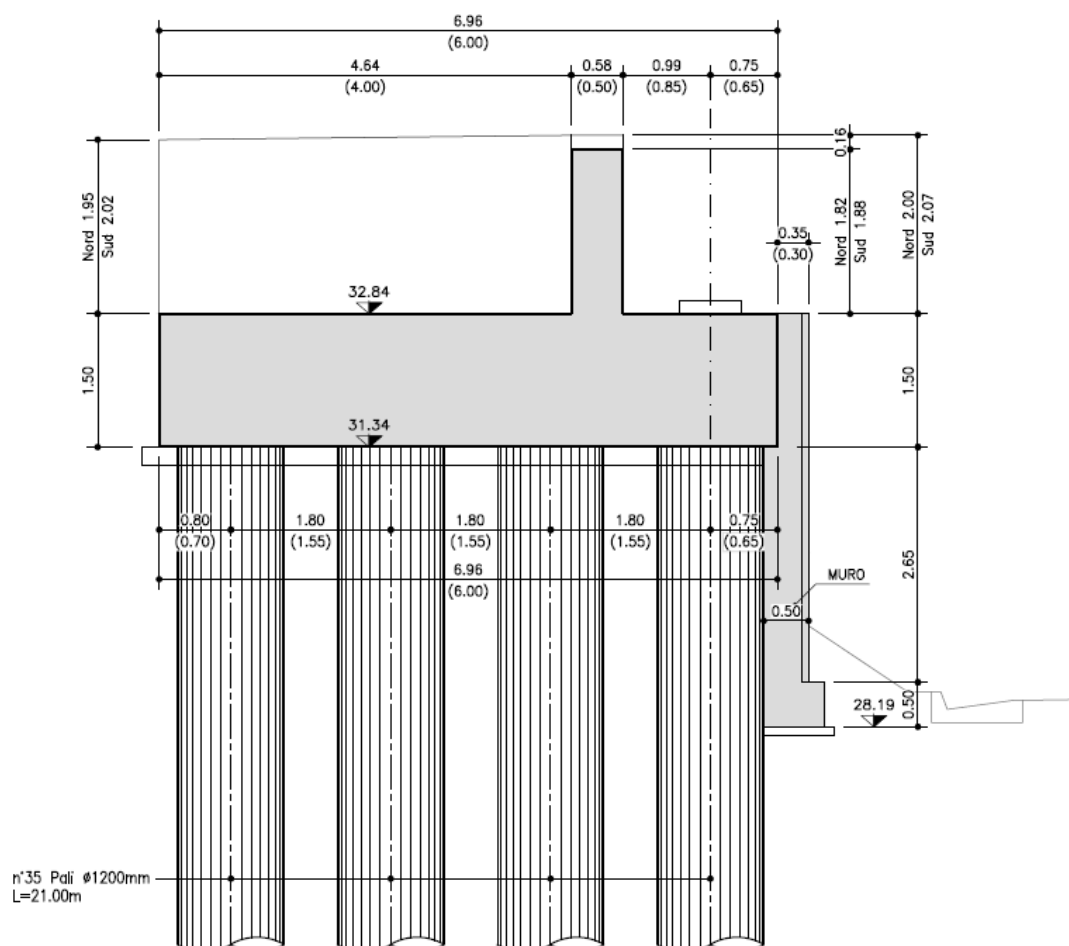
Sezione trasversale della Spalla A
